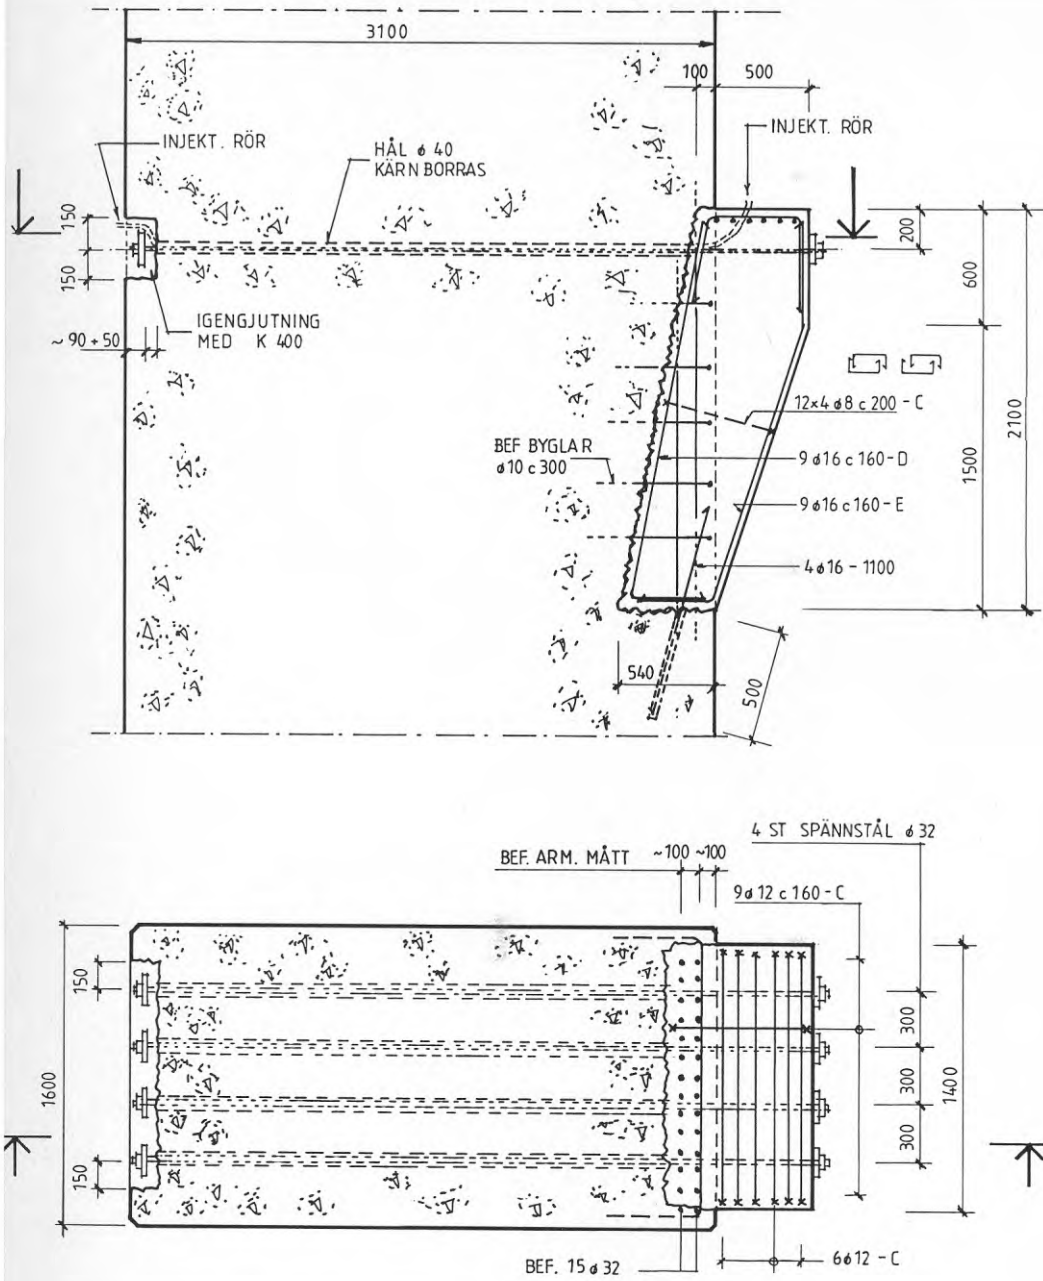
Betongkonsoler i gamla betongpelare för upp-
